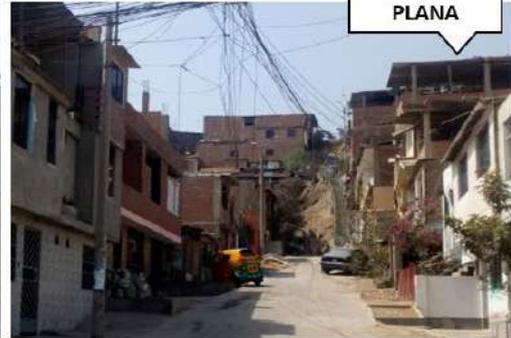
Vista de viviendas en pendiente, desde Calle Central.
